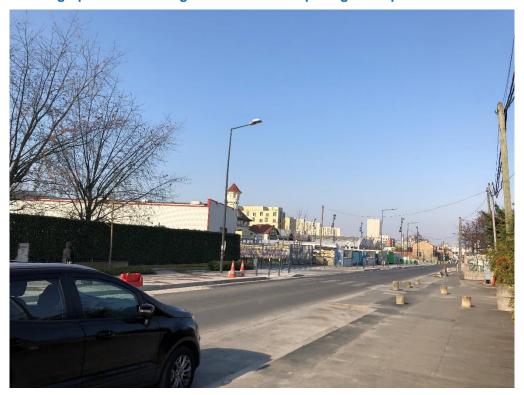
Vue prise à l'Est du site, sur l'avenue Gaston Roussel
